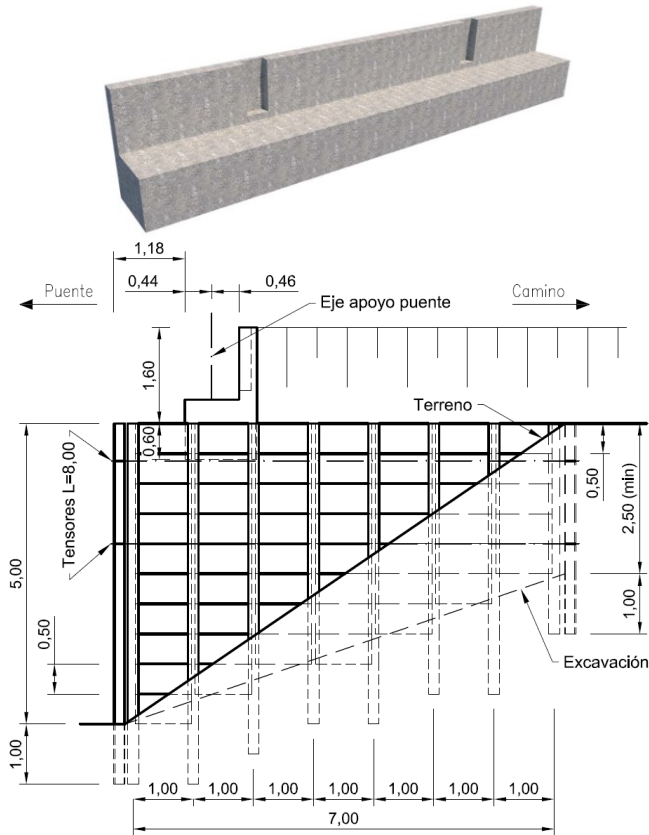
Arriba: Mesa de apoyo de HA. Abajo: Muro de estribo de muros de contención metálicos.
